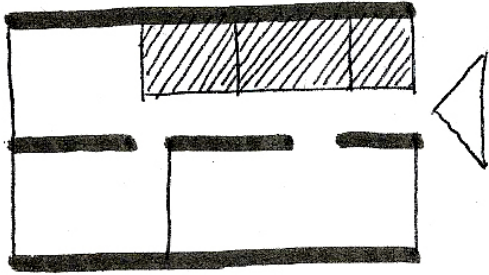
a. b. c. : les exceptions - structure longitudinale avec salle de bain au coeur et structure transversale avec salle de bain en façade.
